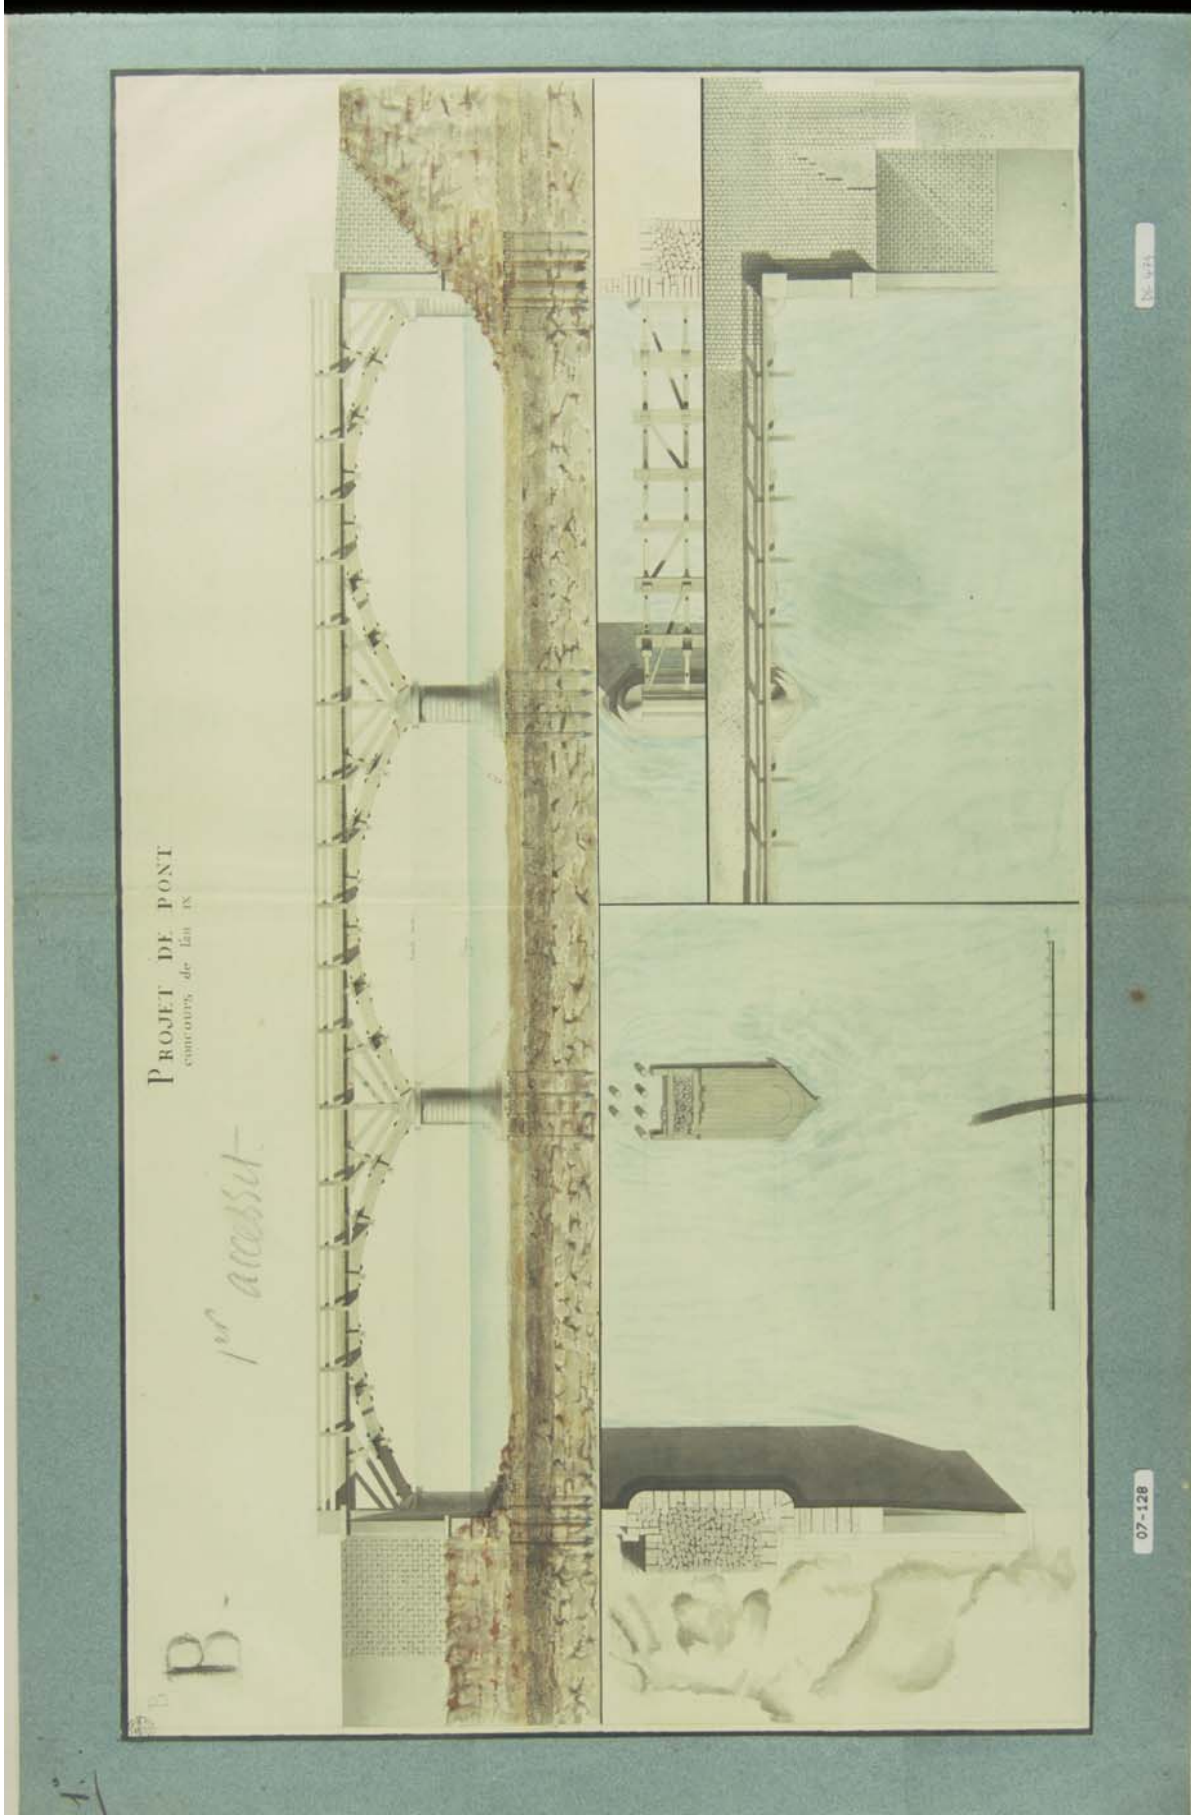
DG 474 – Alexandre Charles Louis Arcelot. Projet de pont en bois. Elevation, plan et detail de la construction. Concours pont. 1800-1801
